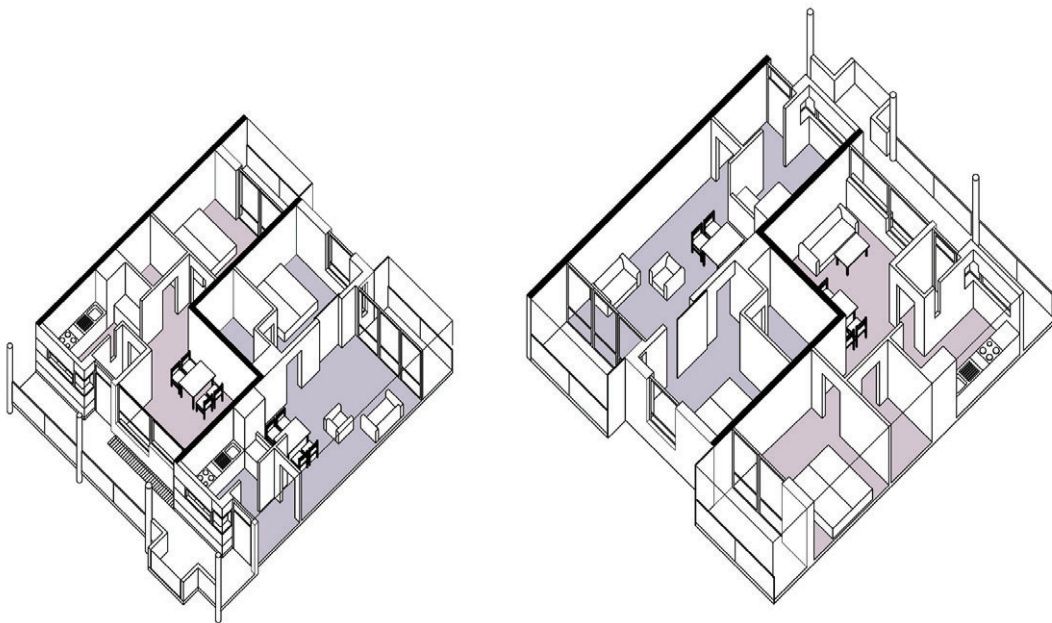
/ Plano plantas 3-5, viviendas para ancianos en violeta.
